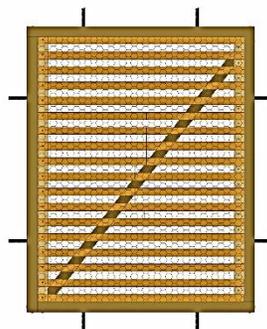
Planimetría estructura interna del Panel autoconstruido en bahareque encementado.
